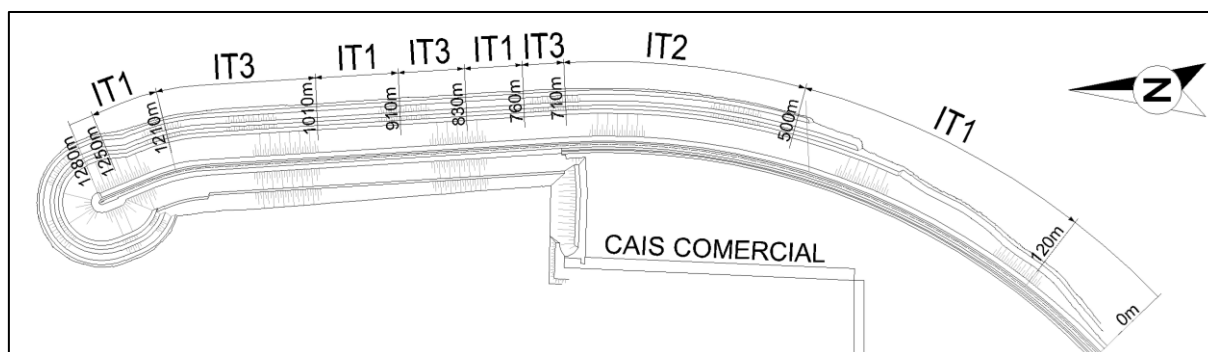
Esquema da Planta do Molhe Sul, reparação concluída em 2008
